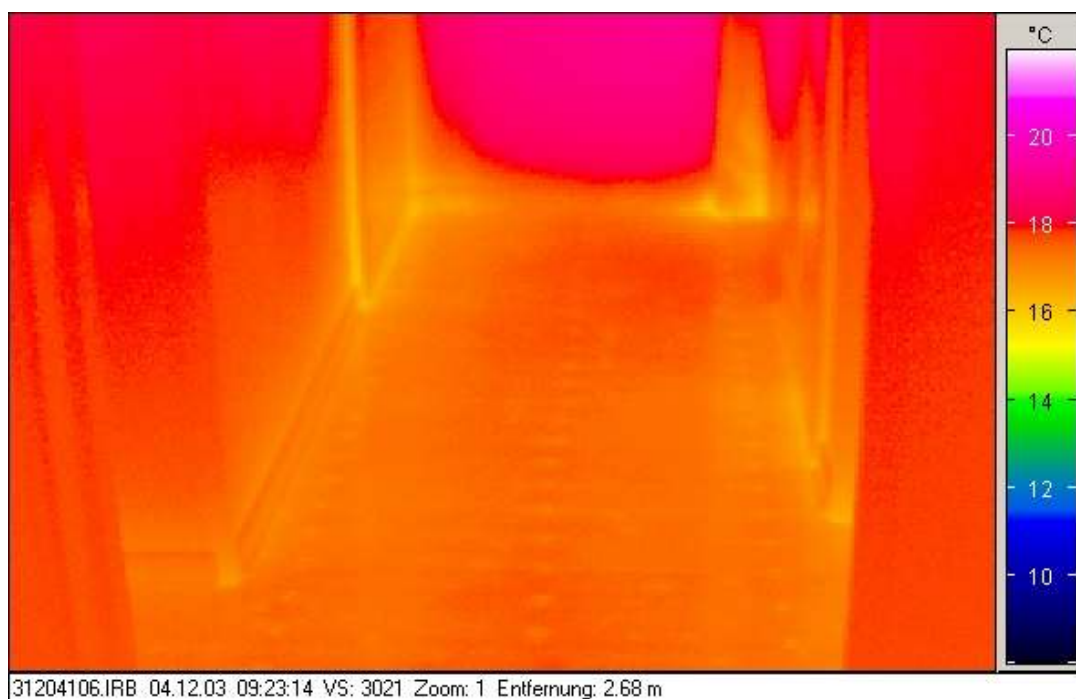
Detail Küchenfenster mit Rolladenkasten und Gurt in der Nordfassade.
